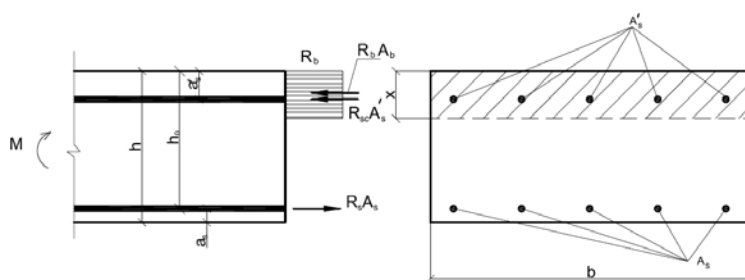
Схема зусиль і епюра напруг у перерізі, нормальному до поздовжньої осі залізобетонного згинального елемента при розрахунку його міцності
